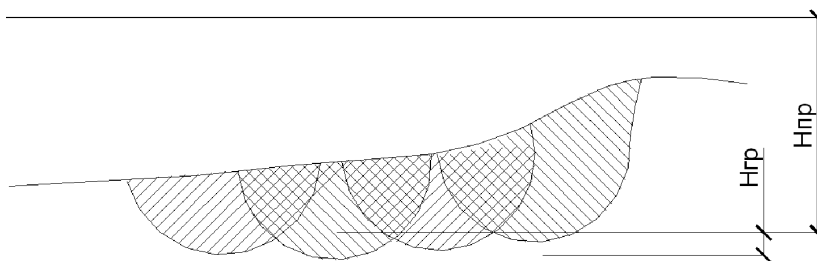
Схема разработки грунта одноковшовым земснарядом
